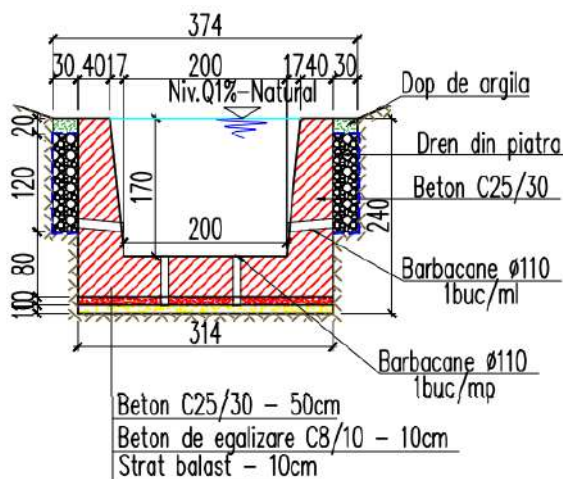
ST1/3 Casetă din beton (B= 2.00 m, H=1.70 m)
